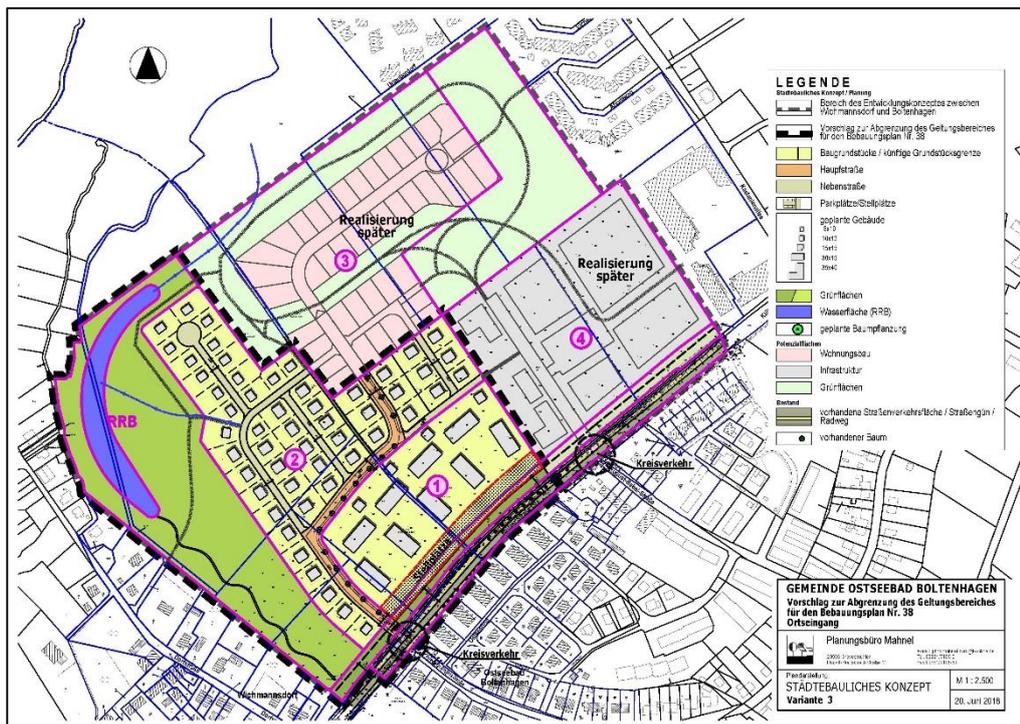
Städtebauliches Konzept mit Darstellung der Teilflächen
